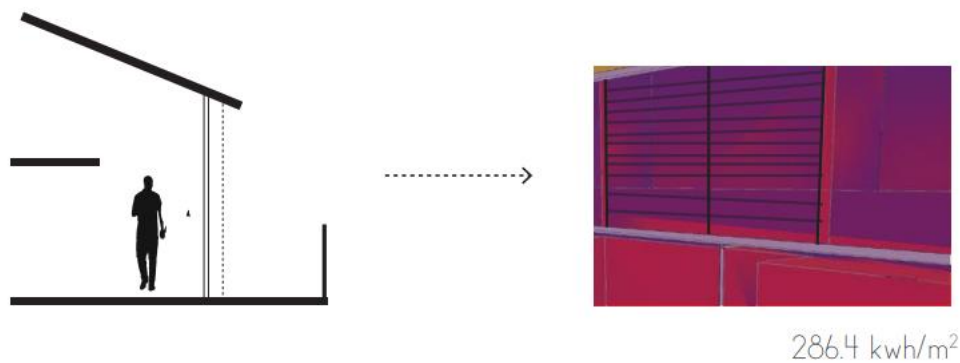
Piel en fachada. Elaborado por Nacevilla 2020
